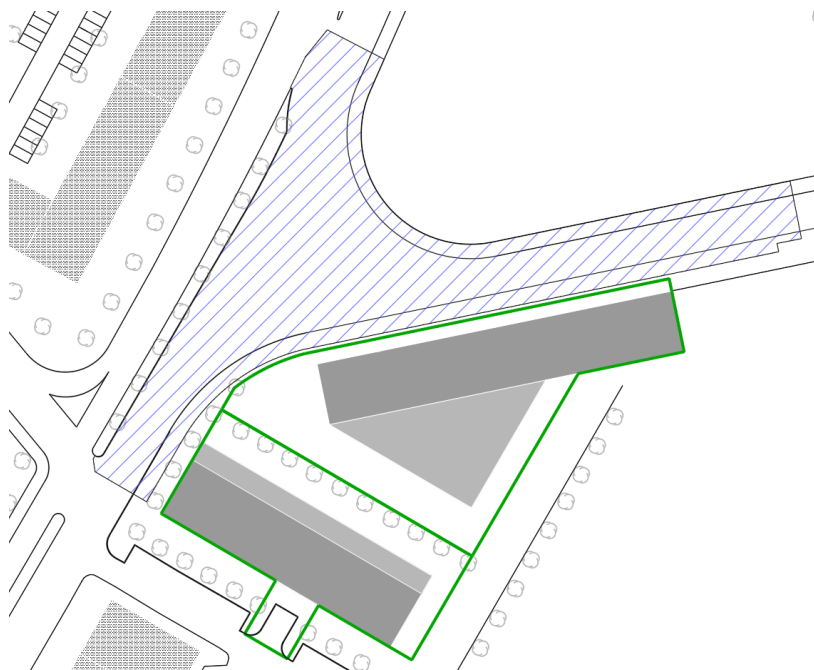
Localização da área de intervenção da interseção e dos lotes adjacentes
